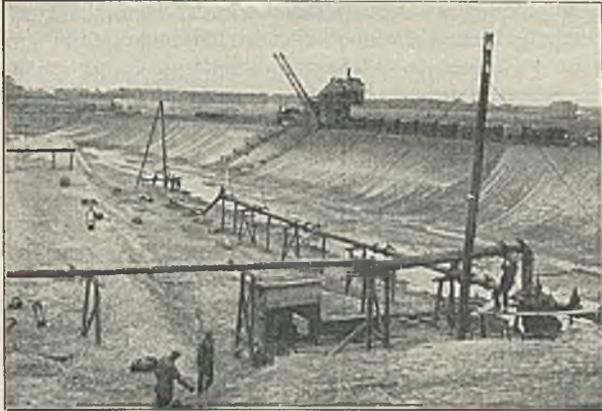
Aushub der Baugrube durch einen Eimerkettenbagger. Einbau der Grundwassersenkungsanlage. Vorn Druckrohrleitung zur Boye.
